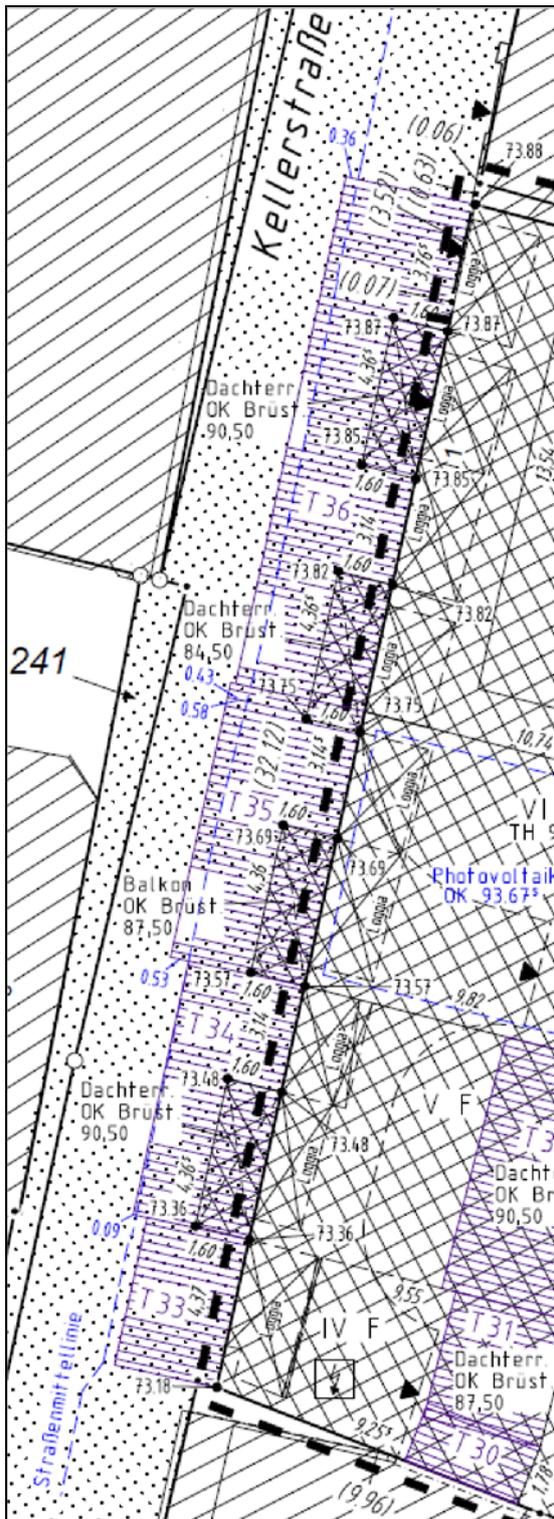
Abstandsflächenermittlung (Vermessungsbüro Wiegen öbVI)
